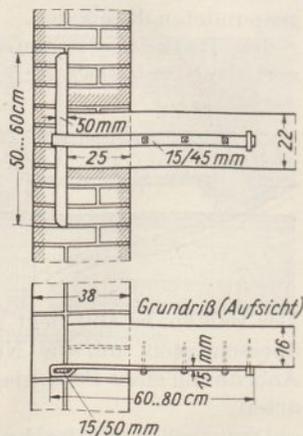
Balkenanker. (Im Grundriß ist das Mauerwerk nicht geschnitten.)
